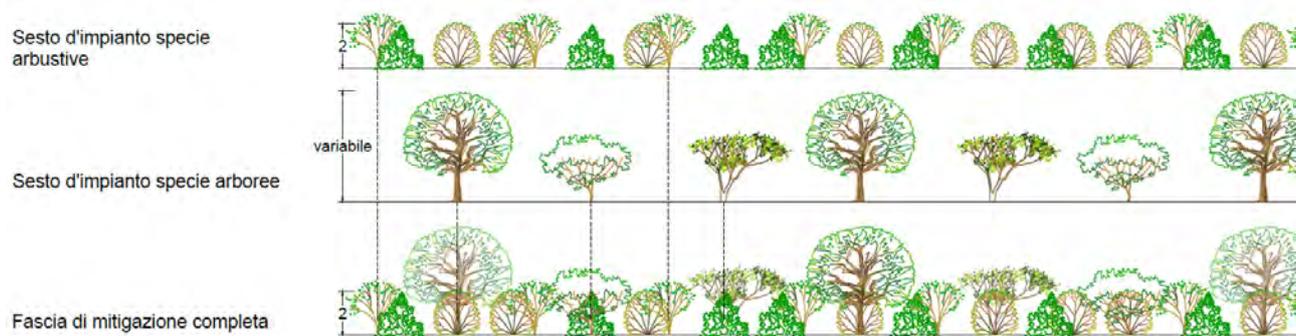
Dettaglio tipologico Fascia di mitigazione A – prospetto
